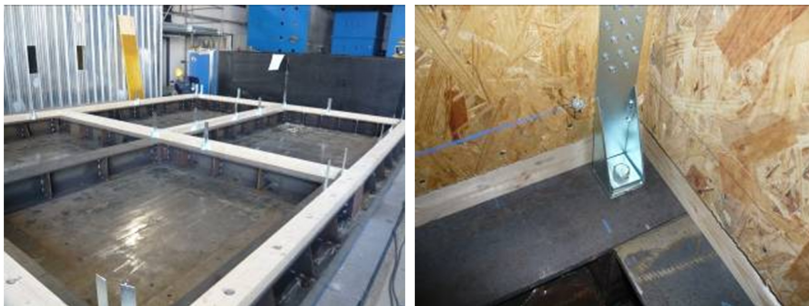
Graticcio di travi in acciaio e collegamento con le pareti strutturali
